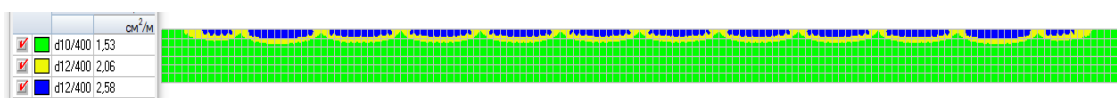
Армирование монолитных стен нижняя по y (комбинация нагрузок С1)
